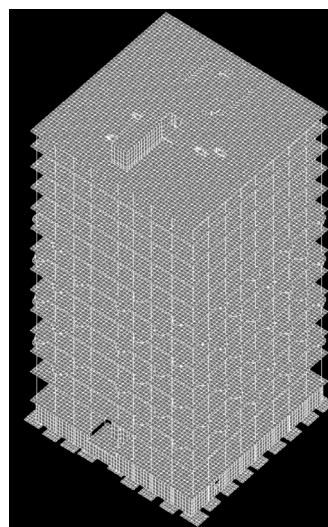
Расчетная схема здания в программе «ОМ СНиП Железобетон»
